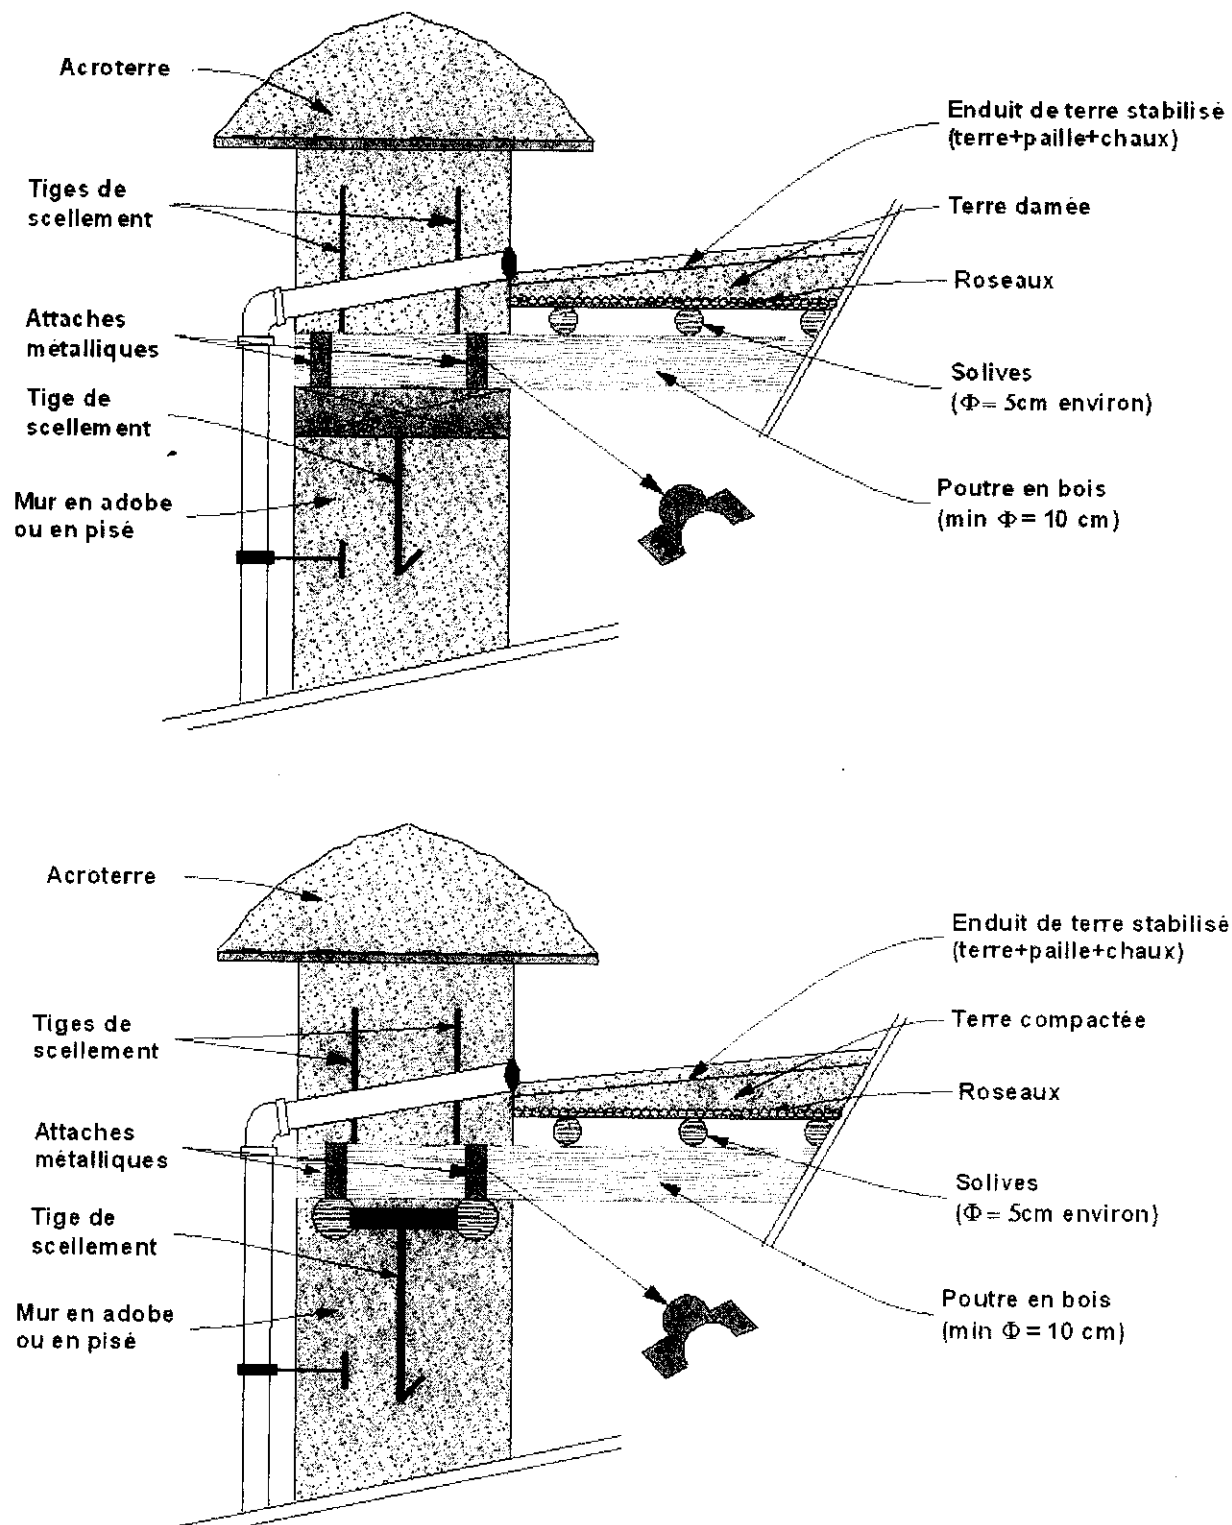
Chaînage horizontal en bois ; Toiture traditionnelle et attaches mur – chaînage et plancher – chaînage
